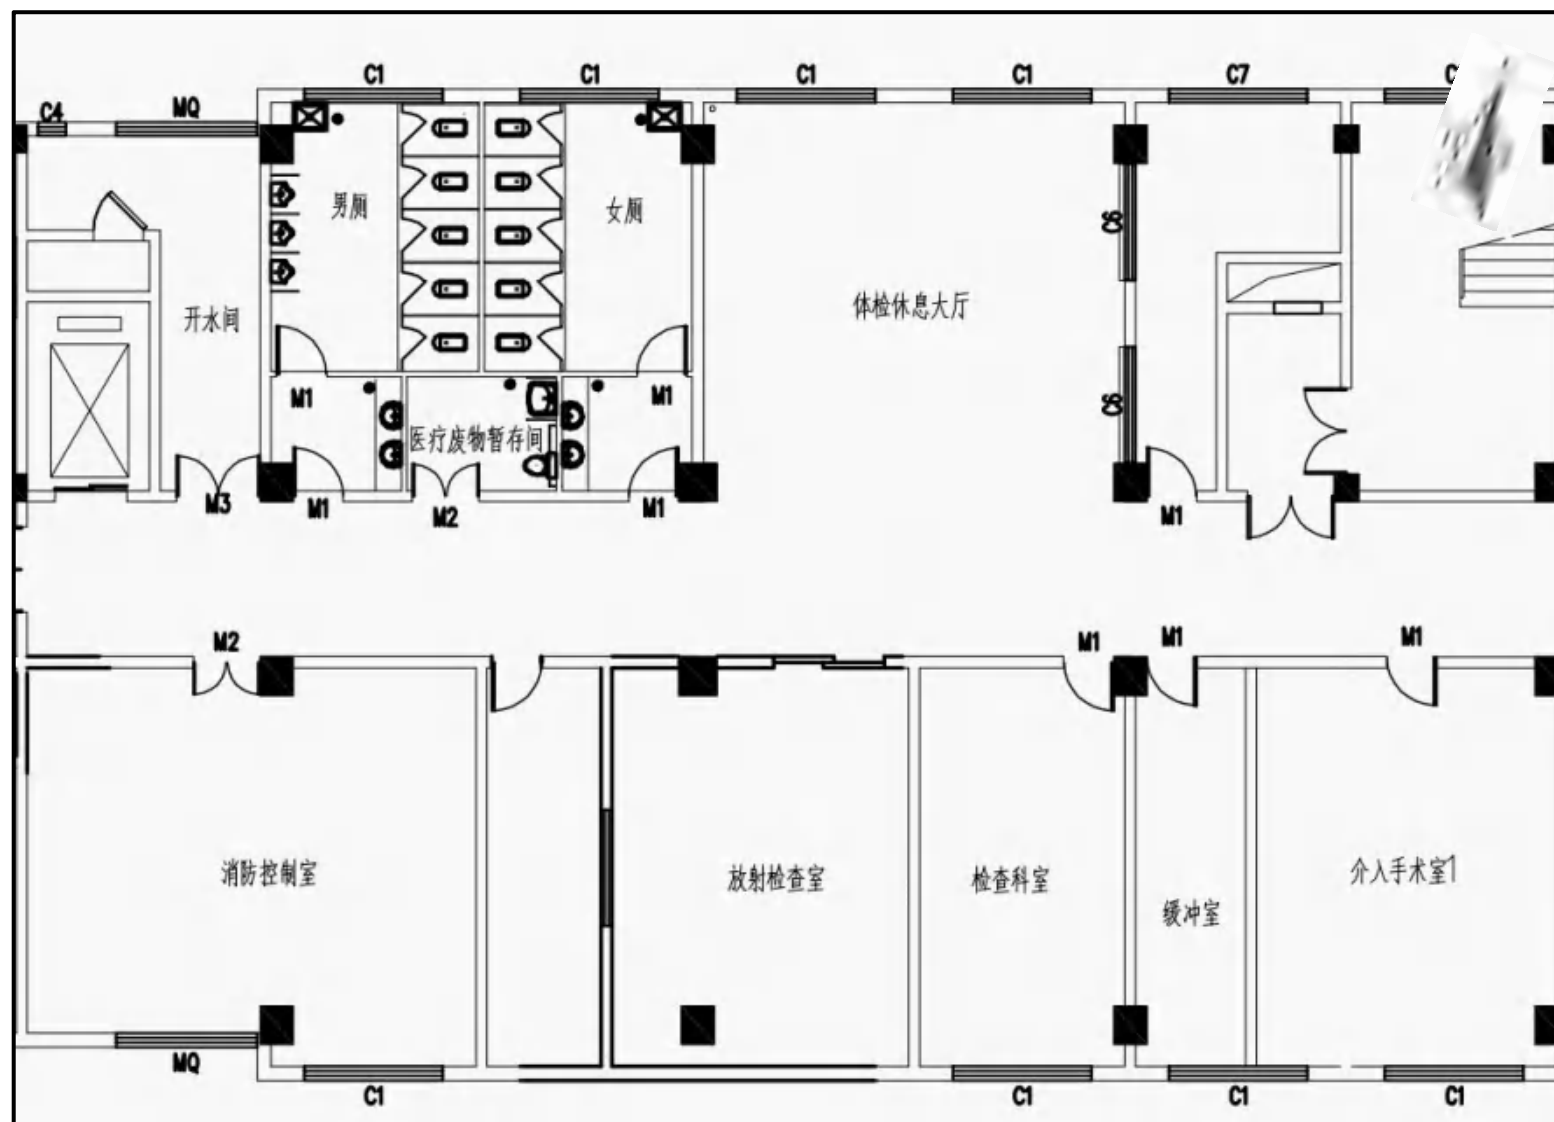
本项目改造前体检休息大厅周边相邻位置平面布局示意图
